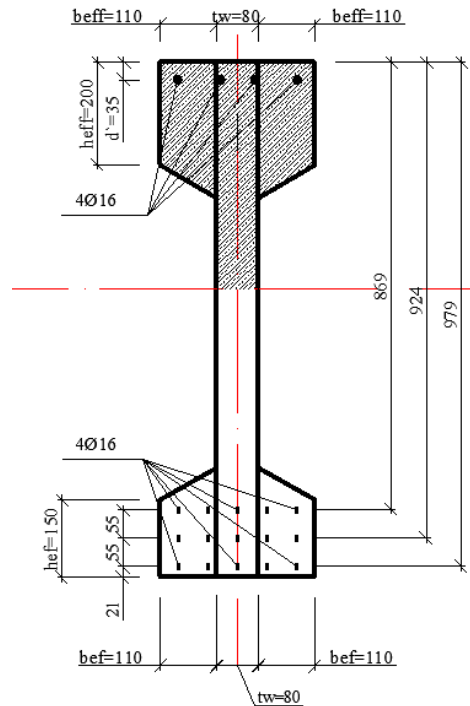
Розрахунковий поперечний переріз балки для її розрахунку за граничними станами II групи.
